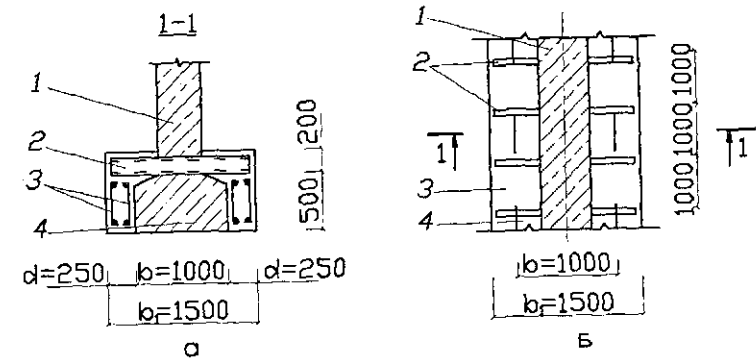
Усиление ленточного фундамента: а — сечение 1—1; б — фрагмент плана усиленного фундамента; 1 — кирпичная стена; 2 — траверса из двух швеллеров; 3 — каркасы дополнительных фундаментных полос из бетона; 4 — существующий фундамент
